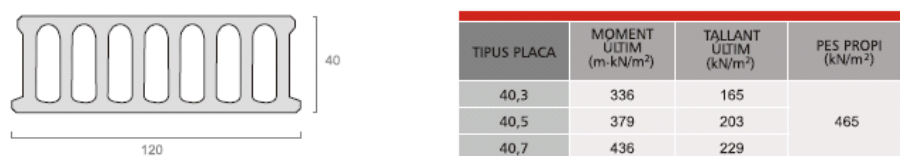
Placa alveolar per la 1^a planta dels aparcaments i rampes
